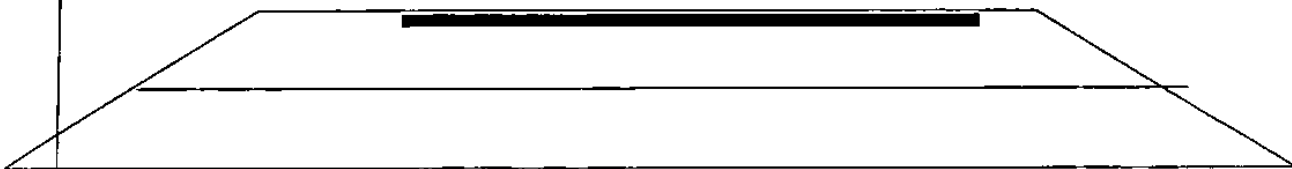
Bentuk geometric konstruksi kotak (*boxed construction*).
